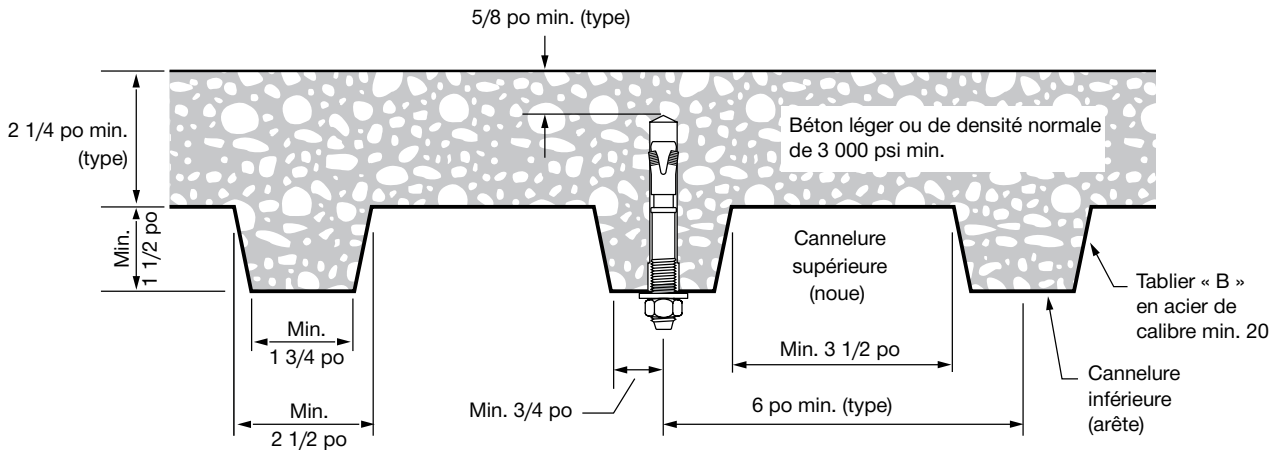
Installation d'une cheville KWIK Bolt TZ de Hilti dans le soffite d'un toit ou d'un plancher en béton sur tablier métallique – tablier « B »
